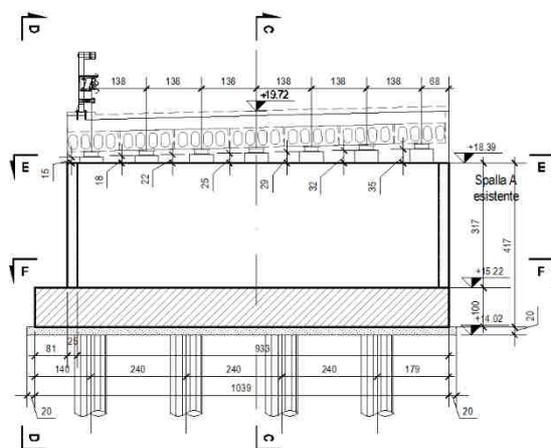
Spalla A prospetto -- Ponte RioSalius
